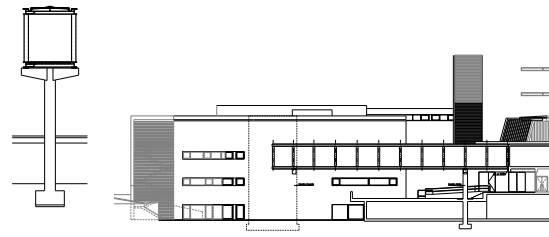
Passadiços metálicos de ligação entre os corpo novo e o existente (Alçado e Corte transversal).
